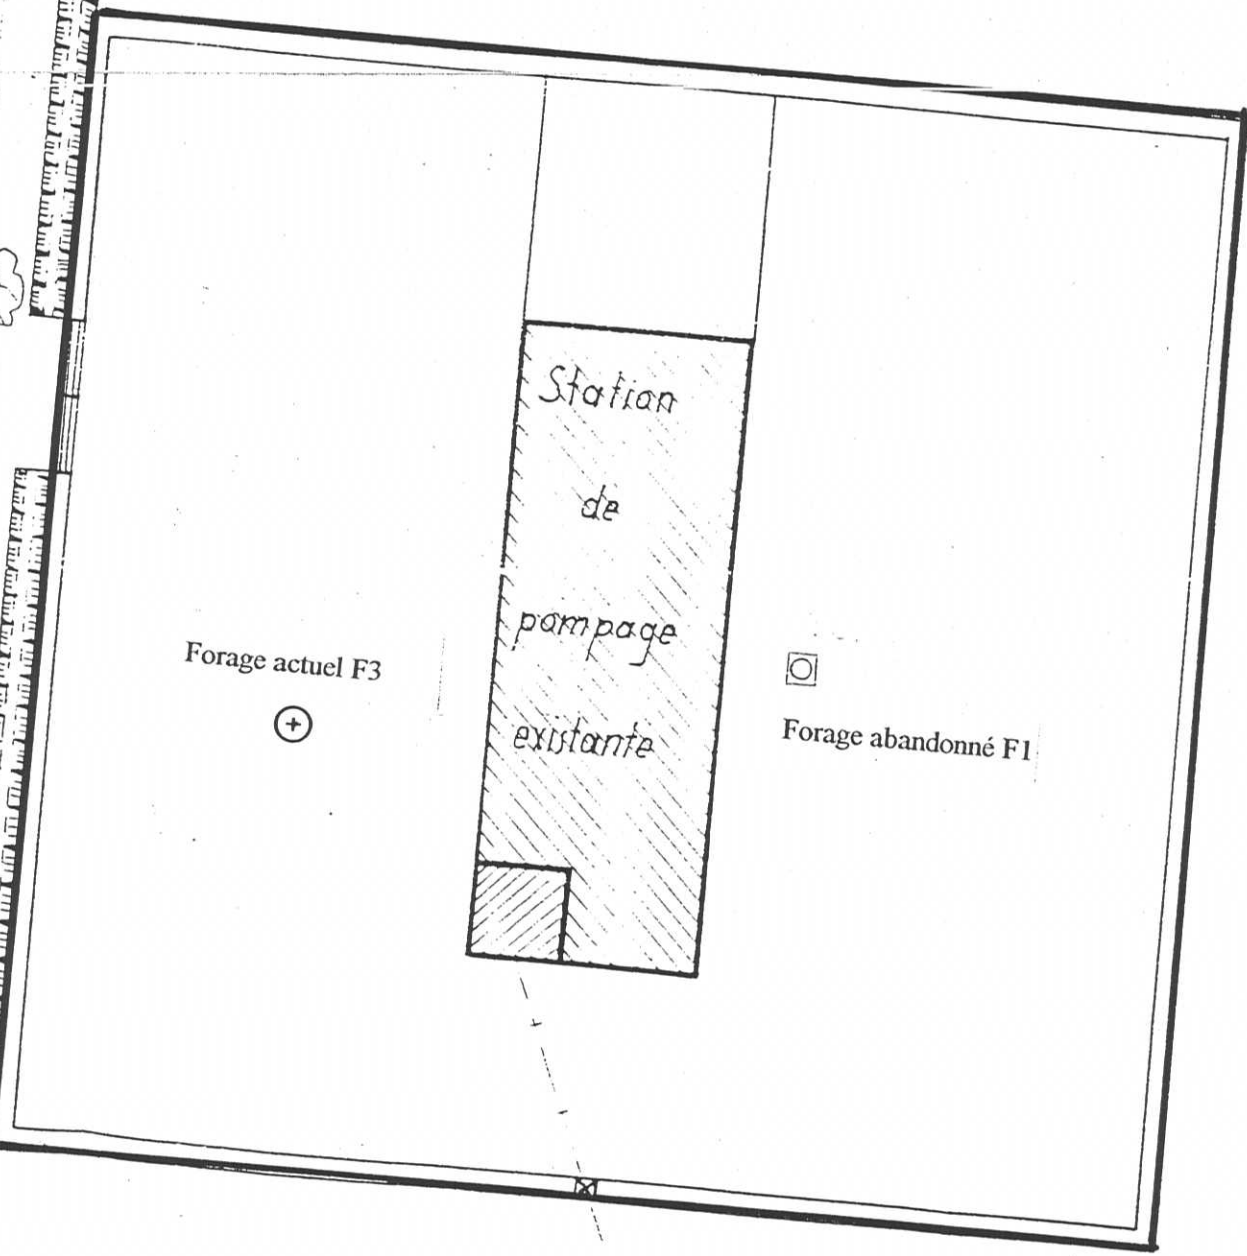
FIGURE D : PLAN DE SITUATION DES FORAGES DE LA STATION
